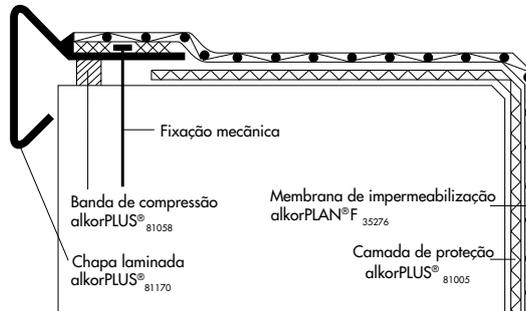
Impermeabilização ao vento por aplicação em sistema independente de outras membranas alkorPLAN®.
